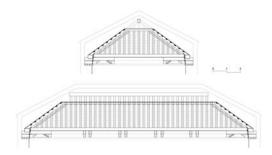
Restitución gráfica. Sección transversal y sección longitudinal
